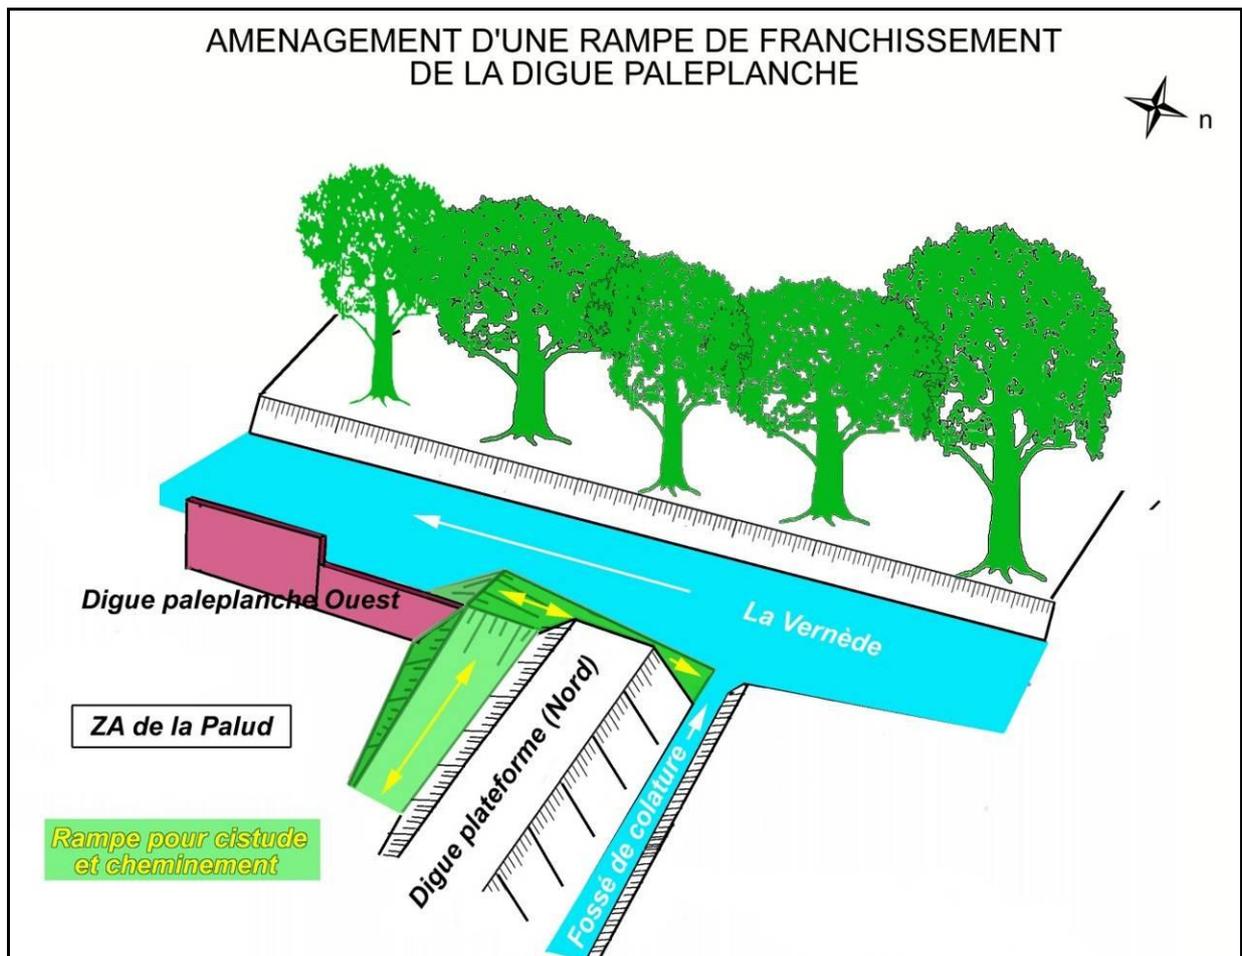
Cistude d'Europe –aménagement d'une rampe de franchissement de la digue palplanche.
